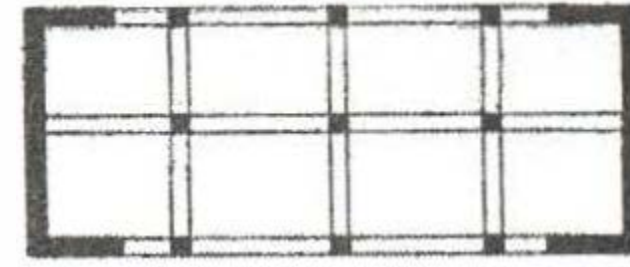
Planda burulma etkisi zorlama yapan planlar
